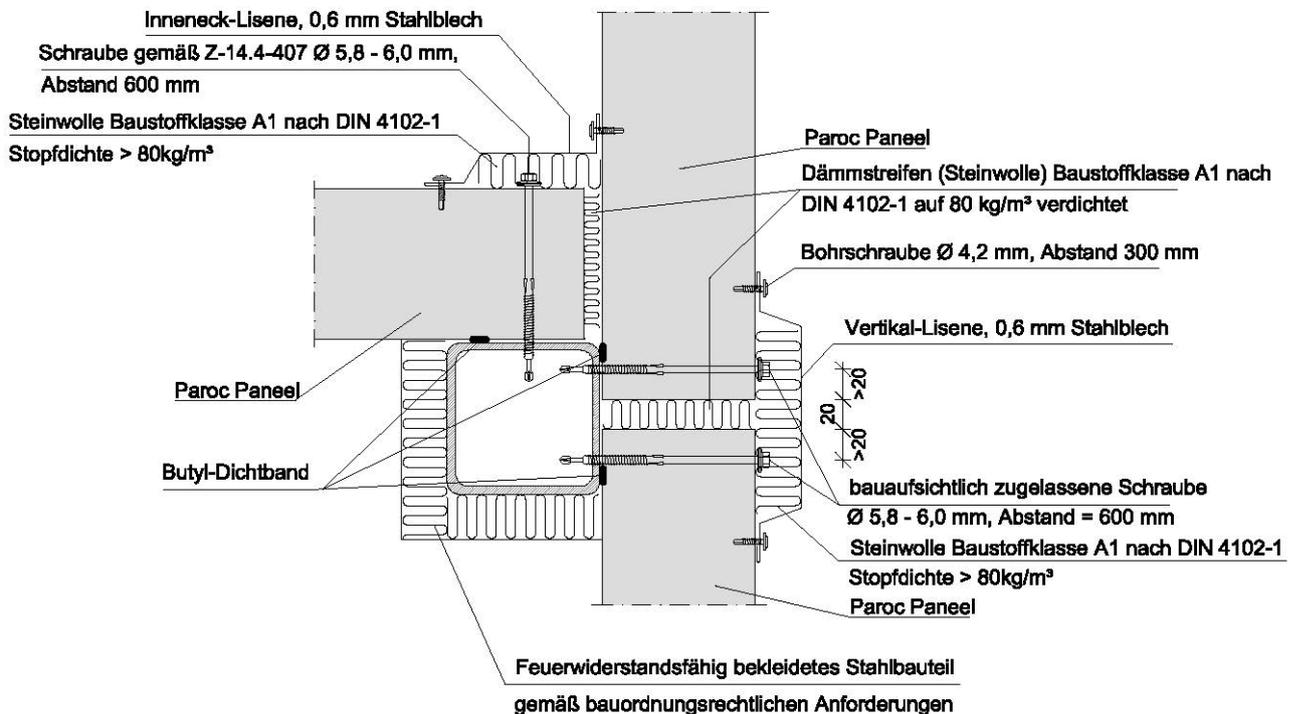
Detail kraftschlüssige Wandanschluss an Stahlstütze
